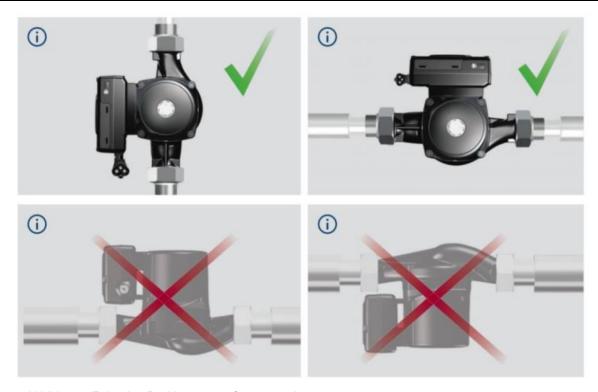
Zulässige Positionen vom Steuerungskasten
